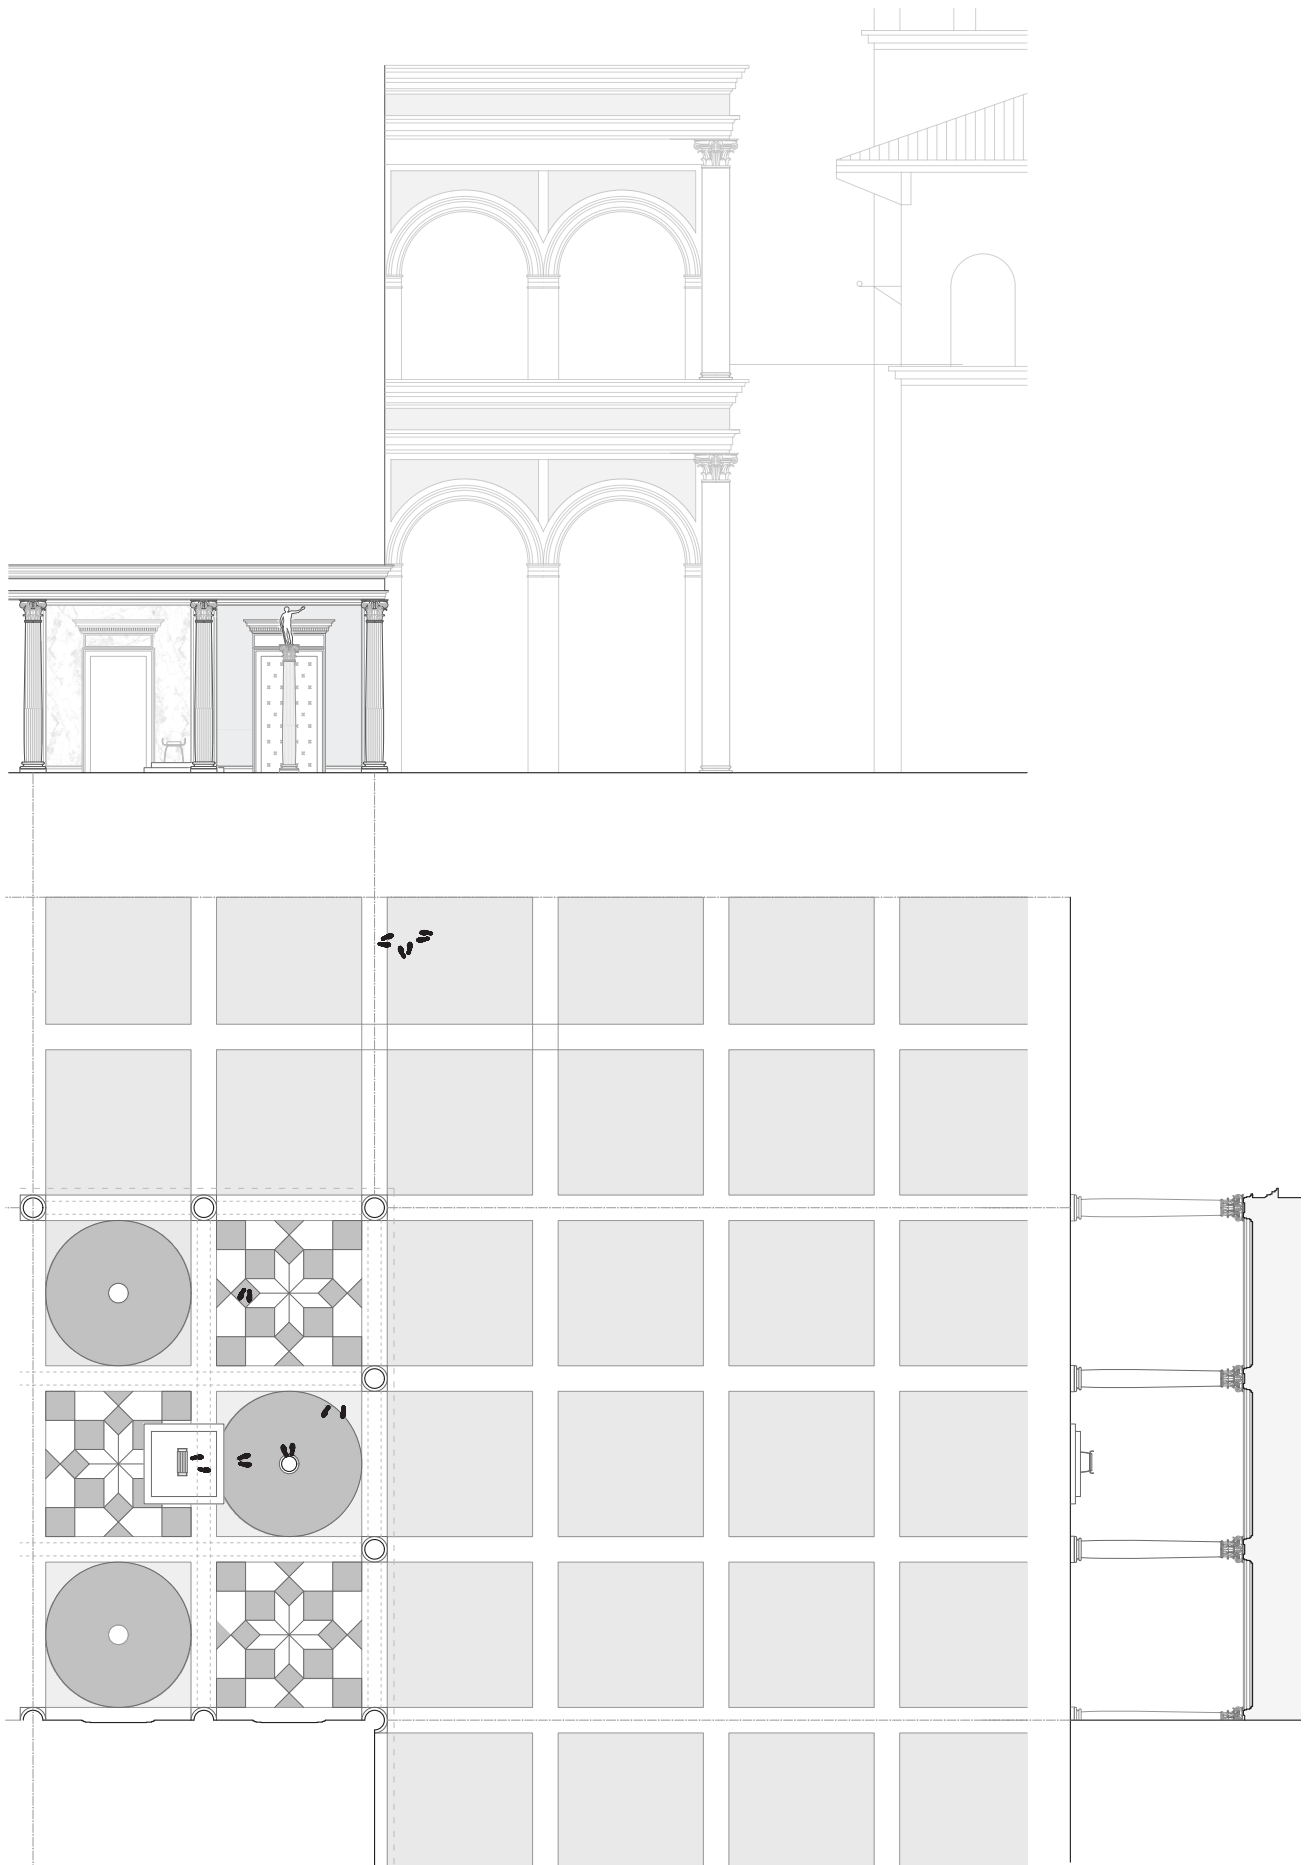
Planta, alzado y sección restituidas de La Flagelación.
